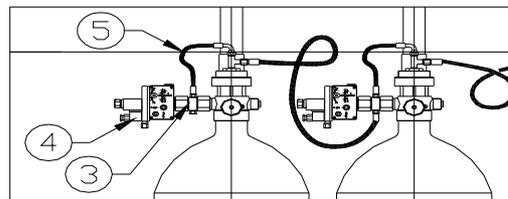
Dettaglio valvola di scarica e collettore pneumatico
